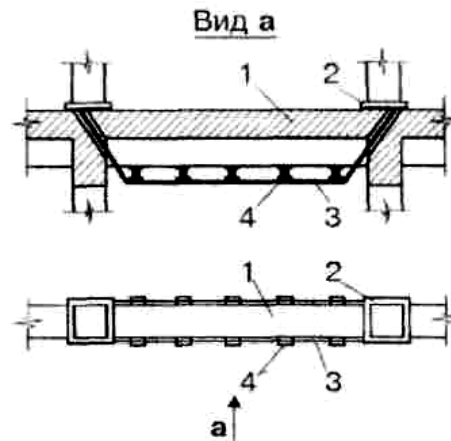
Конструктивна схема підсилення залізобетонної балки затяжками:
